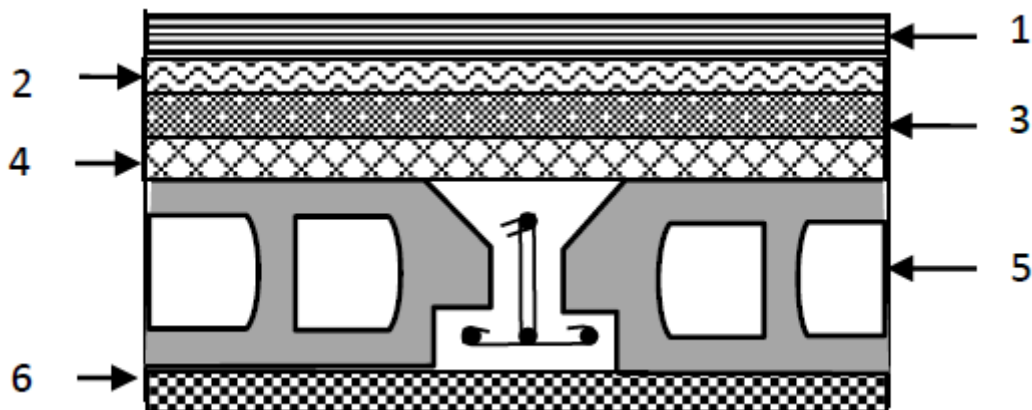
Coupe transversale dans le plancher terrasse inaccessible.
